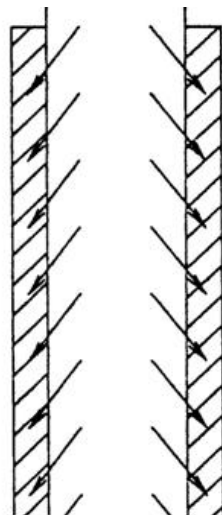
Consolidación de un pilar de hormigón armado mediante camisa de hormigón
